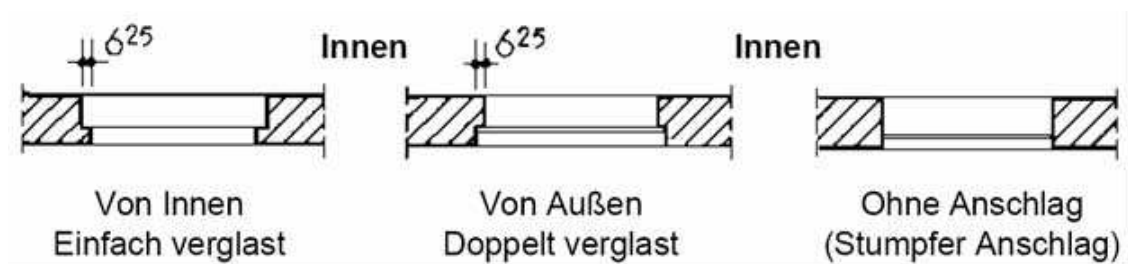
Darstellung verschiedener Fensterformen im Grundriss [7]
